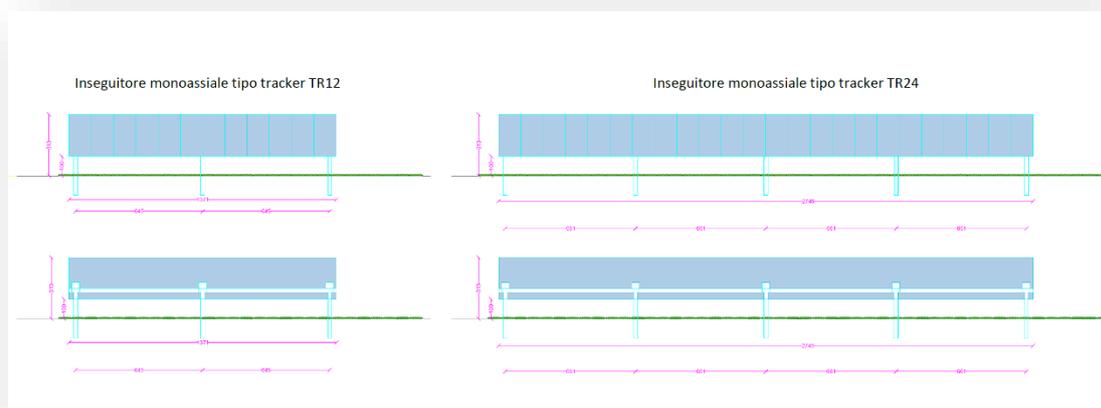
Estratto elaborato 38 (Prospetti tipo impianto)
